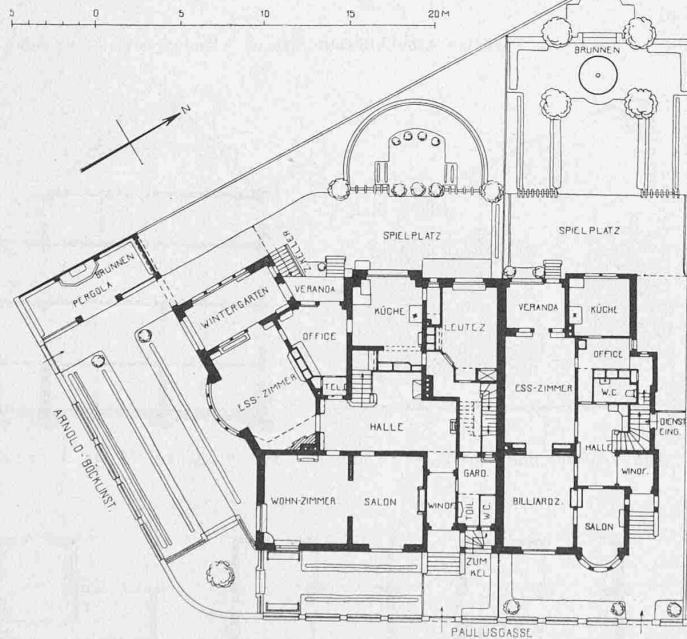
Paulusgasse Nr. 16 und 14. — Grundrisse 1 : 400.
